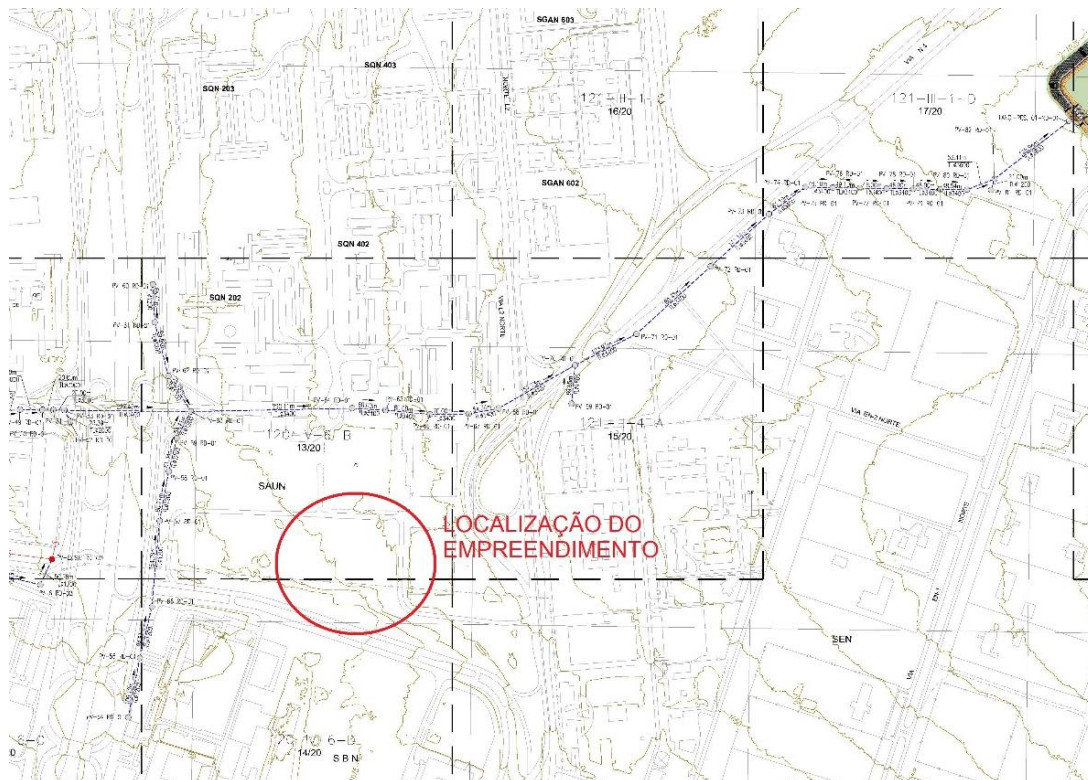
Ampliação de trecho da Planta Geral do projeto de drenagem de Águas Pluviais da Faixa 1-2 Norte –Programa DRENAR DF. Fonte: Terracap.
